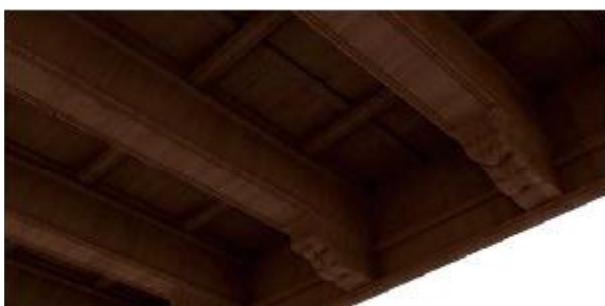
Artesonado completo del salón de la nave. Modelado y renderizado en ArchiCAD. Autor: Álvaro García.
